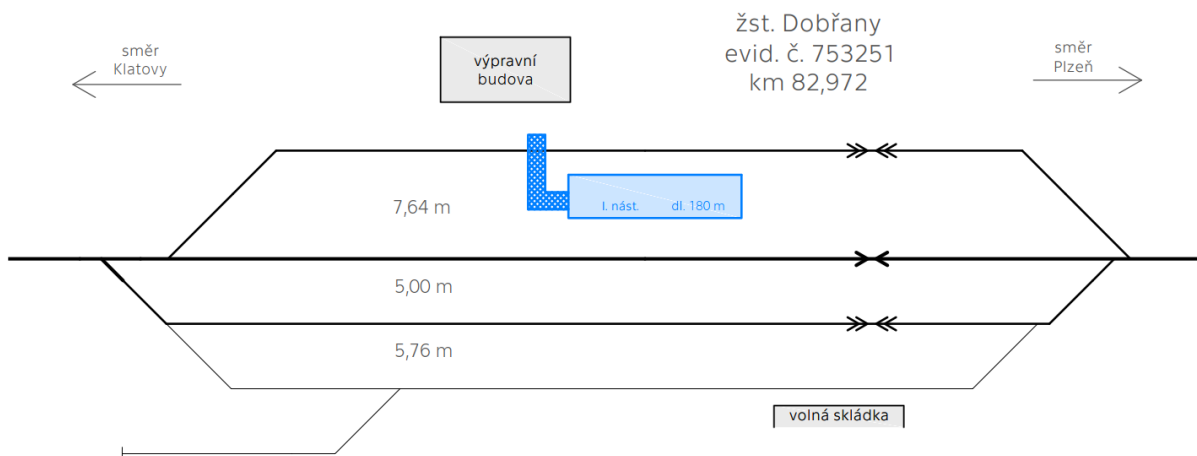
Dopravní schéma žst. Dobřany – varianta A
